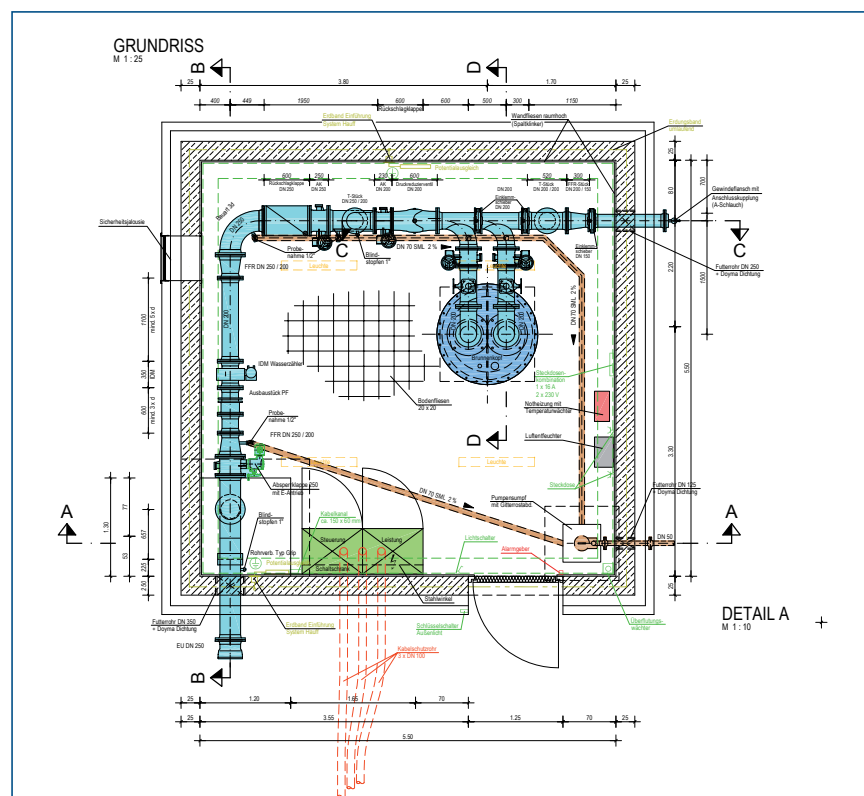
Grundriss Brunnenstube, Brunnen 5
